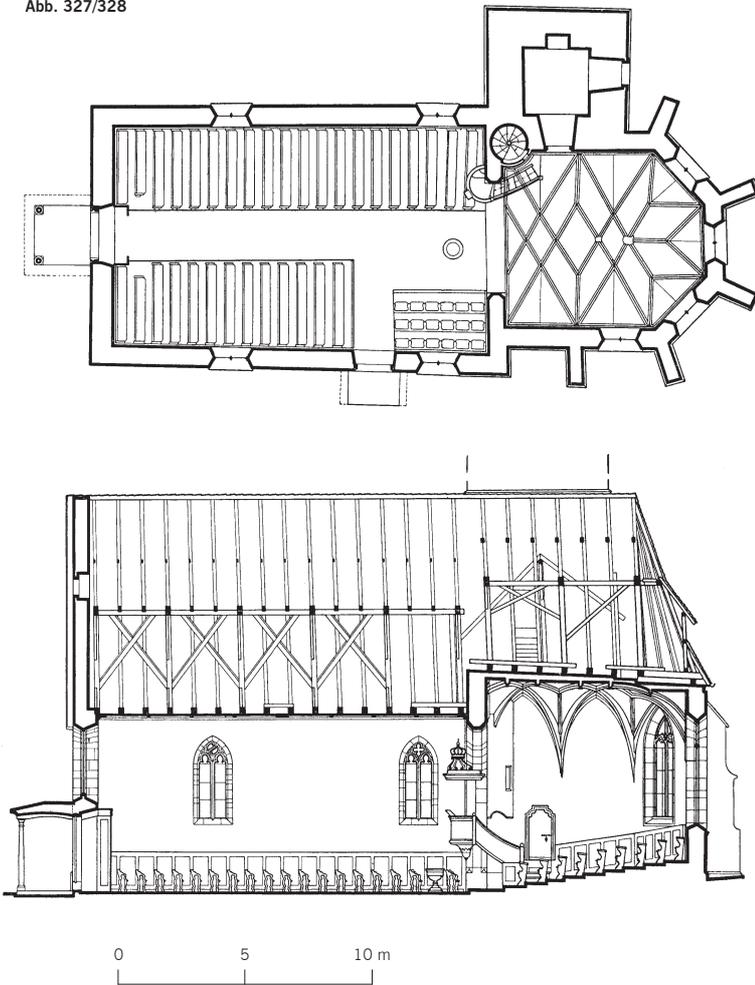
/328: Maschwanden ZH, Pfarrkirche. Grundriss und Längsschnitt 1:300.
